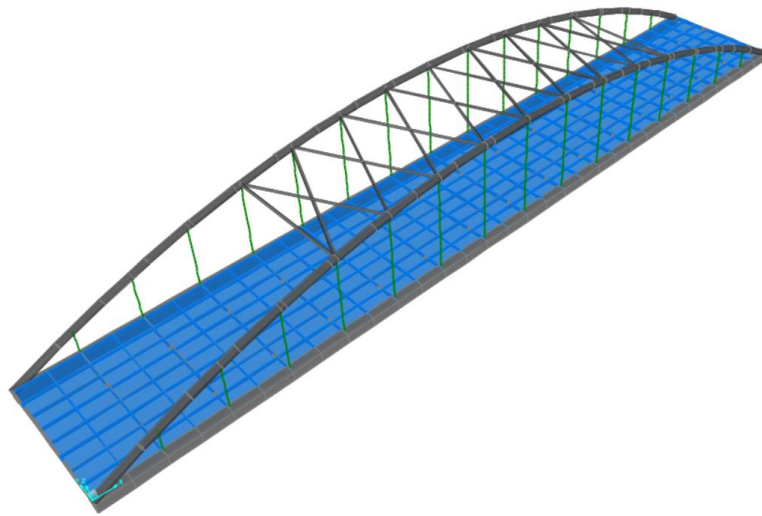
Vista general alternativa 4. (Fuente: elaboración propia en SAP2000).
